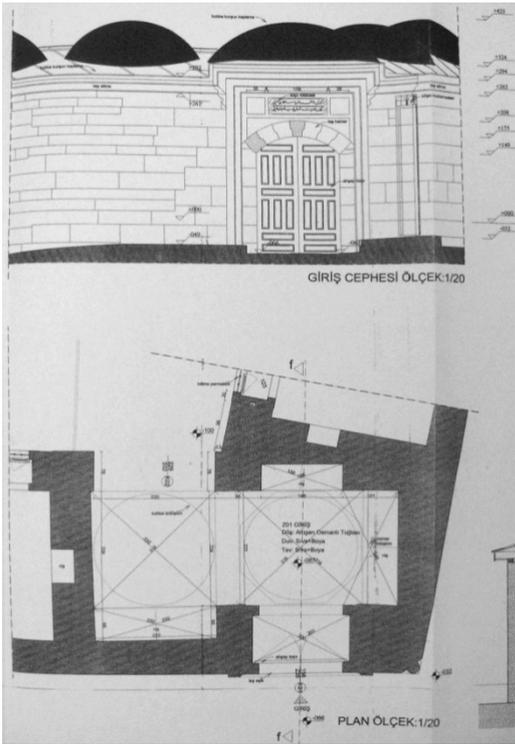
Restaurierungsplan, Ansicht und Grundriss des Eingangs, 2007
